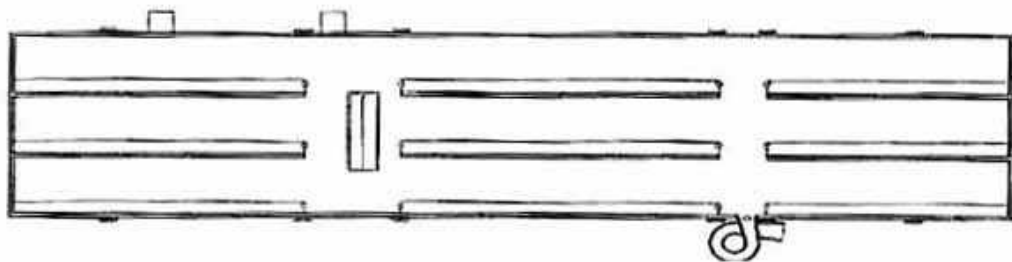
Edifício Castelo Branco – planta do pavimento superior antes da intervenção.
